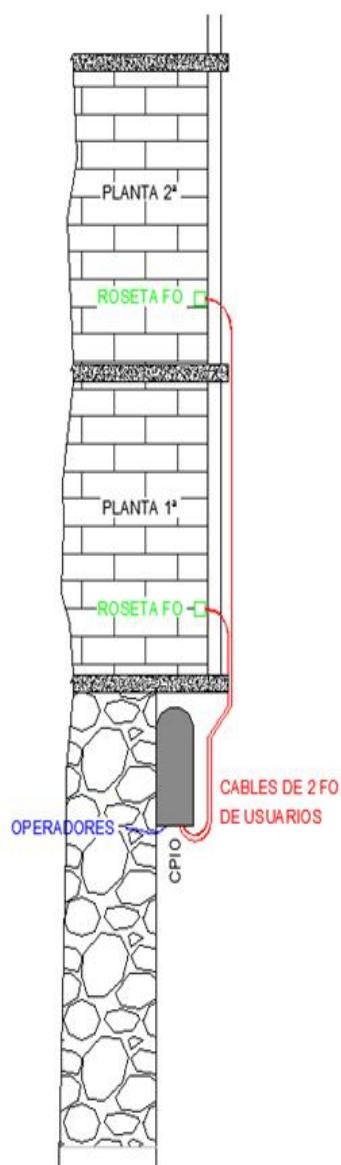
Distribución por fachada. CPIO, Cables de 2 fibras ópticas y roseta. Sin escala (S/E)
